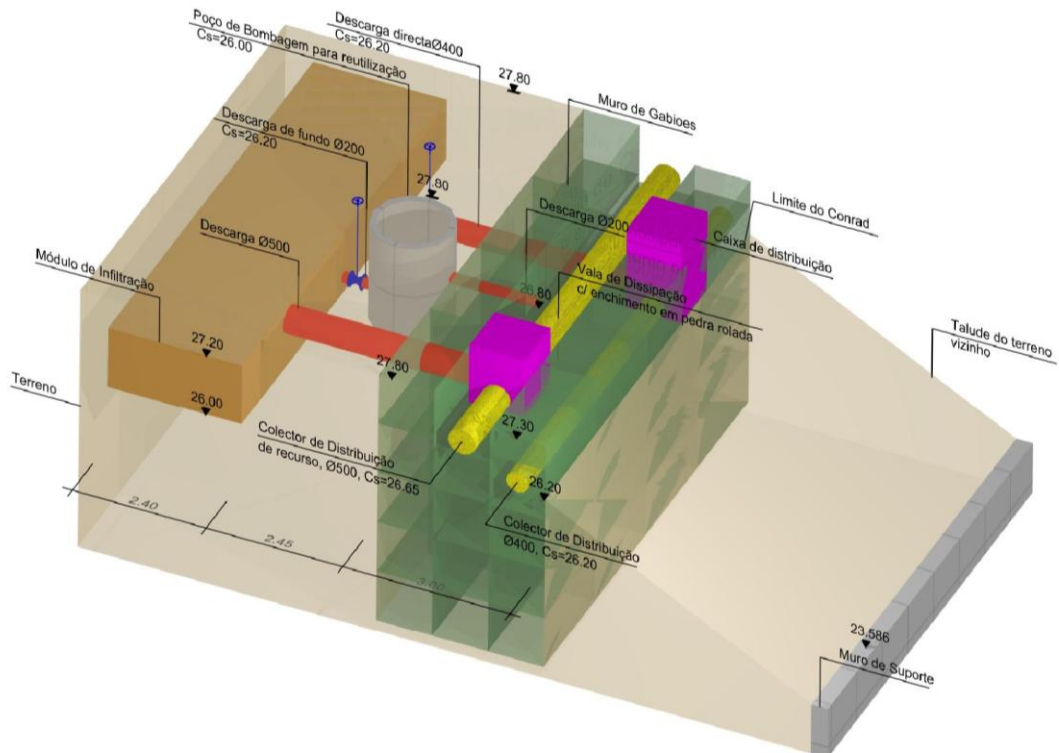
Esquema de ligação da bacia de retenção (a castanho), ao sistema de drenagem pluvial.
